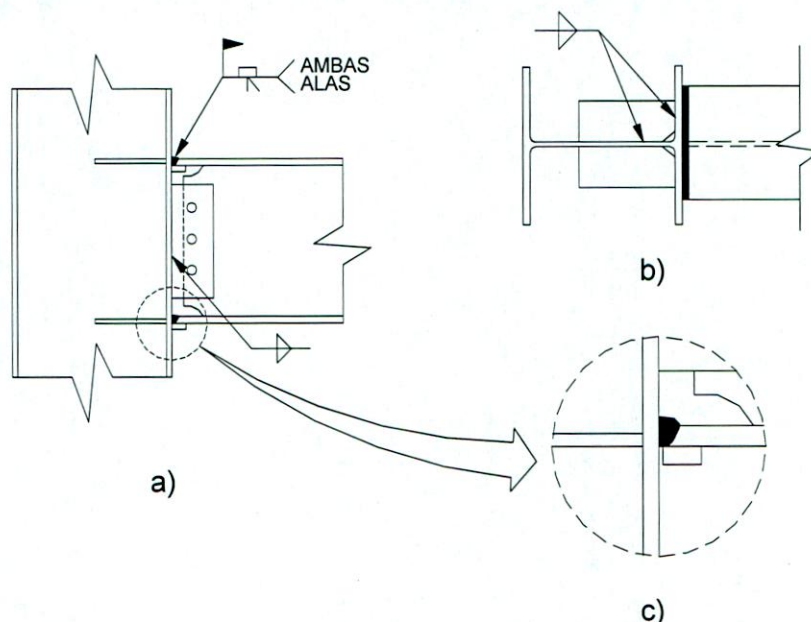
Típica conexión de momento de alma apernada y alas soldadas: a) Elevación, b) Planta, c) Detalle
